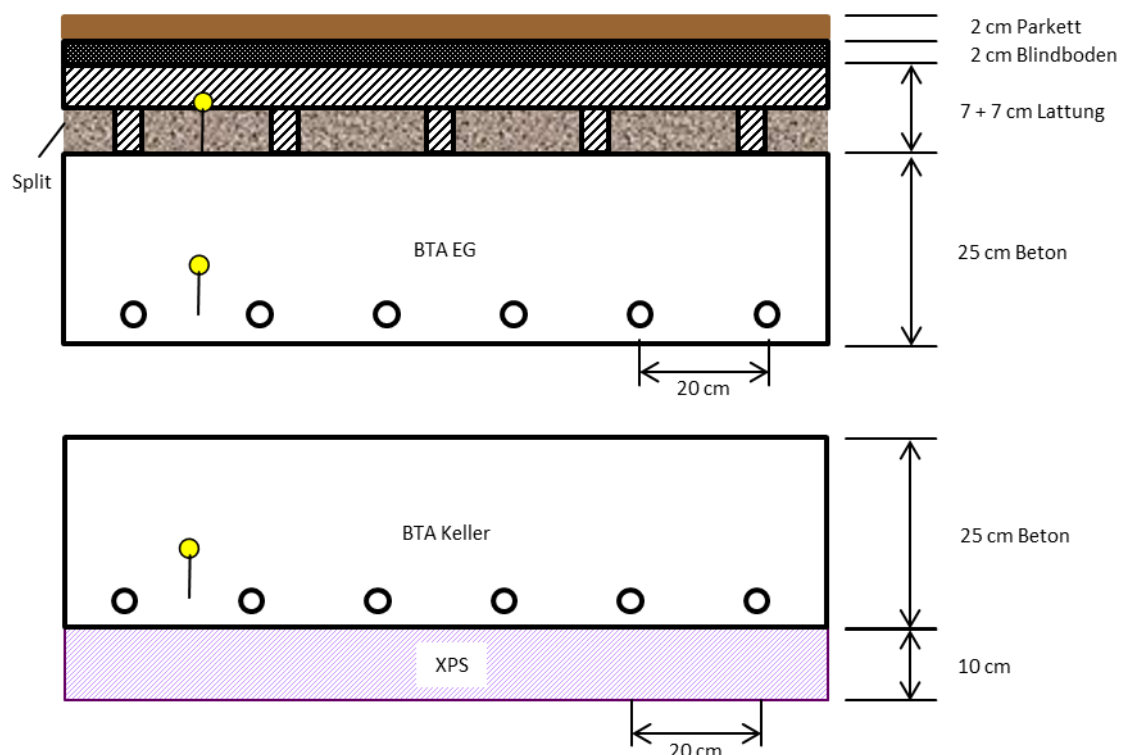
Aufbau der bauteilaktivierten Bodenplatte (Keller) bzw. der Zwischendecke (EG) inkl. Fußbodenaufbau (Quelle: Planer, eigene Darstellung)
